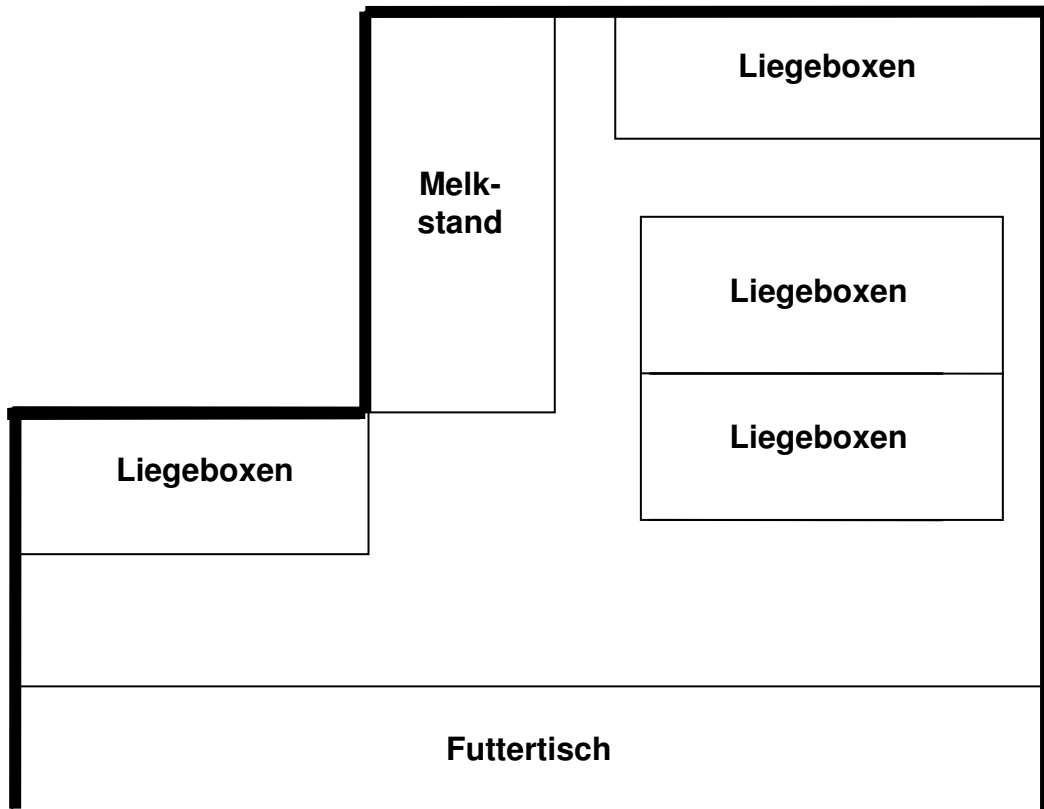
Grundriss-Skizze des untersuchten Stallabteils des alten Stalls
